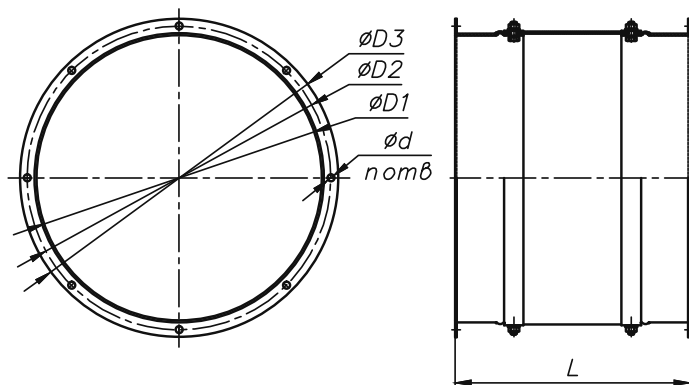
Габаритные и присоединительные размеры гибких вставок круглых ГВ-В.
